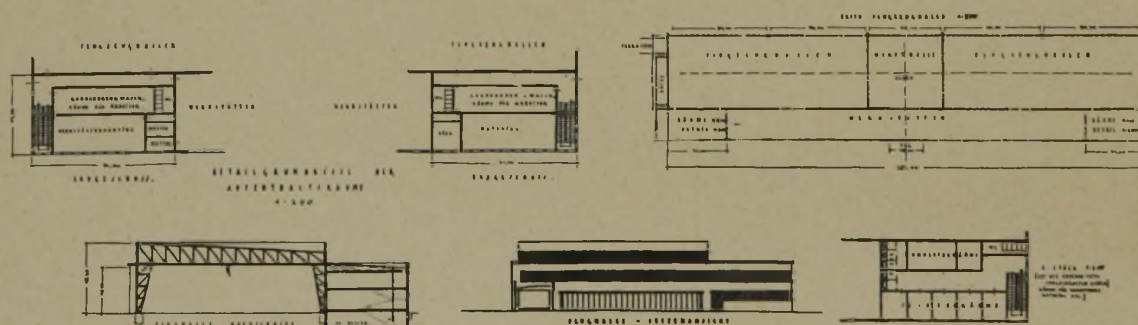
Ges. Grundriß (1 : 4000). Teil-Grundrisse, Schnitt und Ansicht der Flugzeughallen (1 : 1600).
